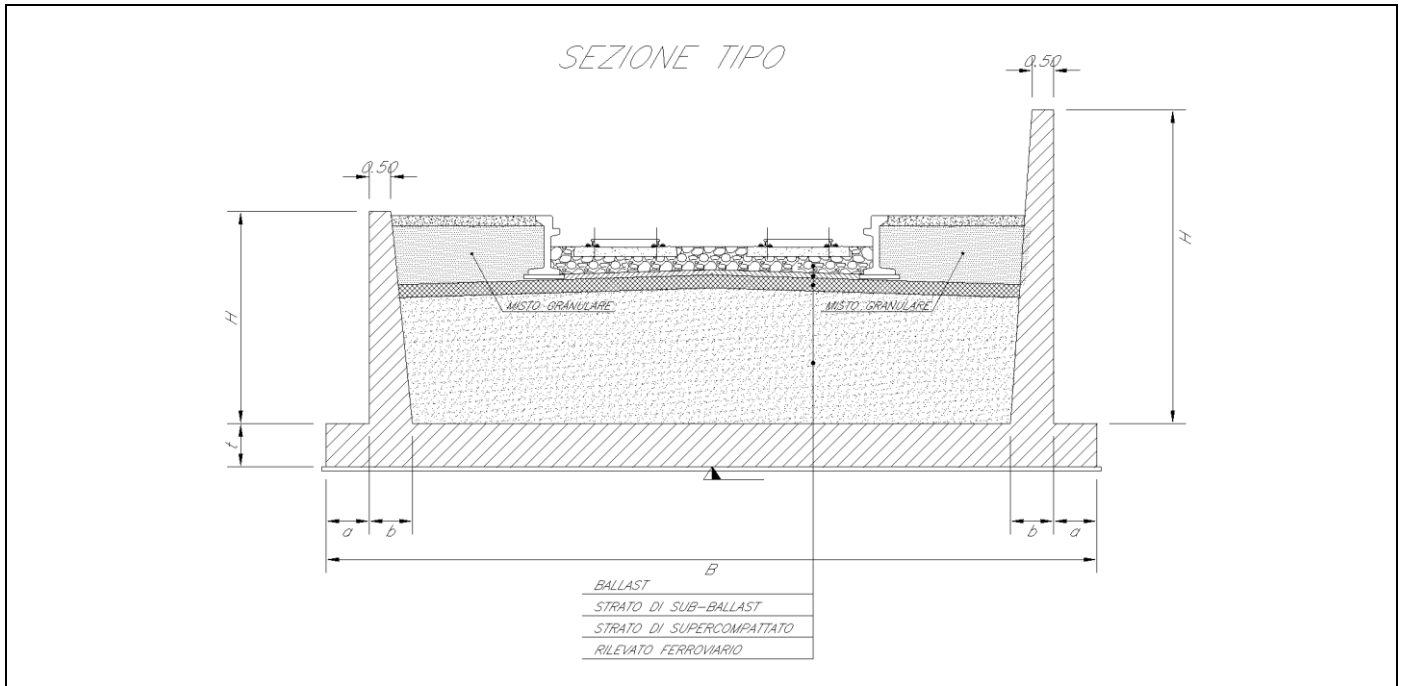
Sezione trasversale tipica conci da 1 a 7
